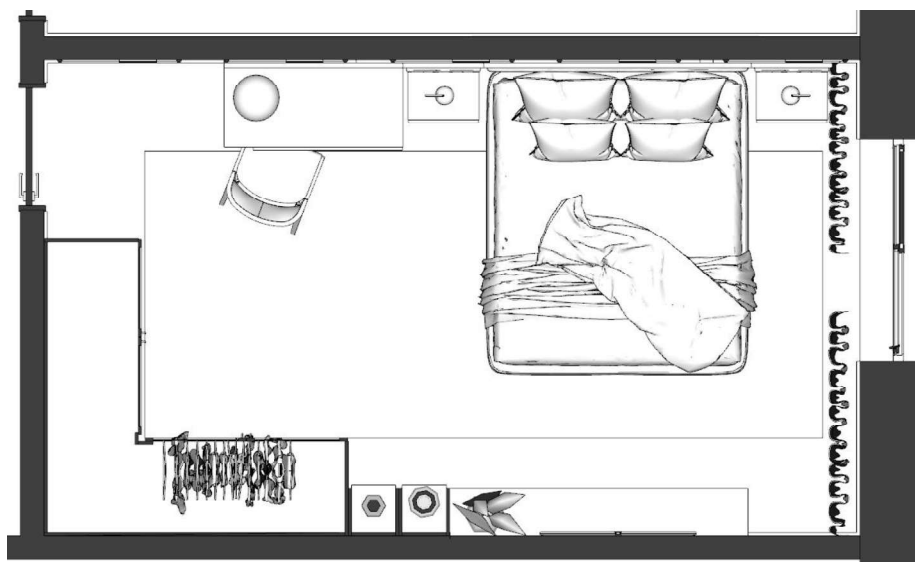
Planta s/escala, Quarto I. *Fonte:* Autora.
